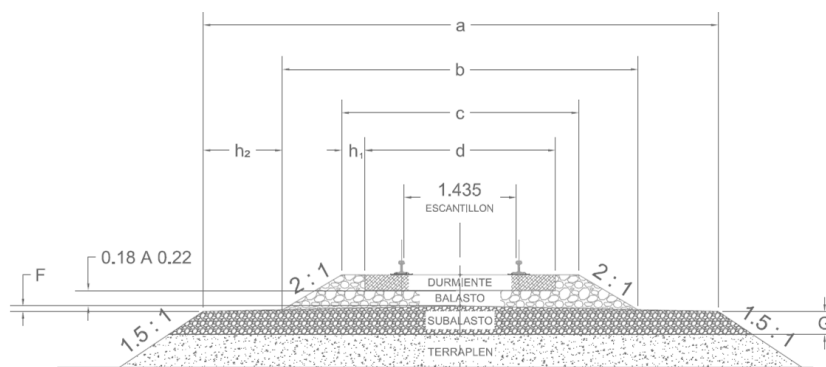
Figura XVI.A. Sección transversal de la vía del ladero de apoyo
